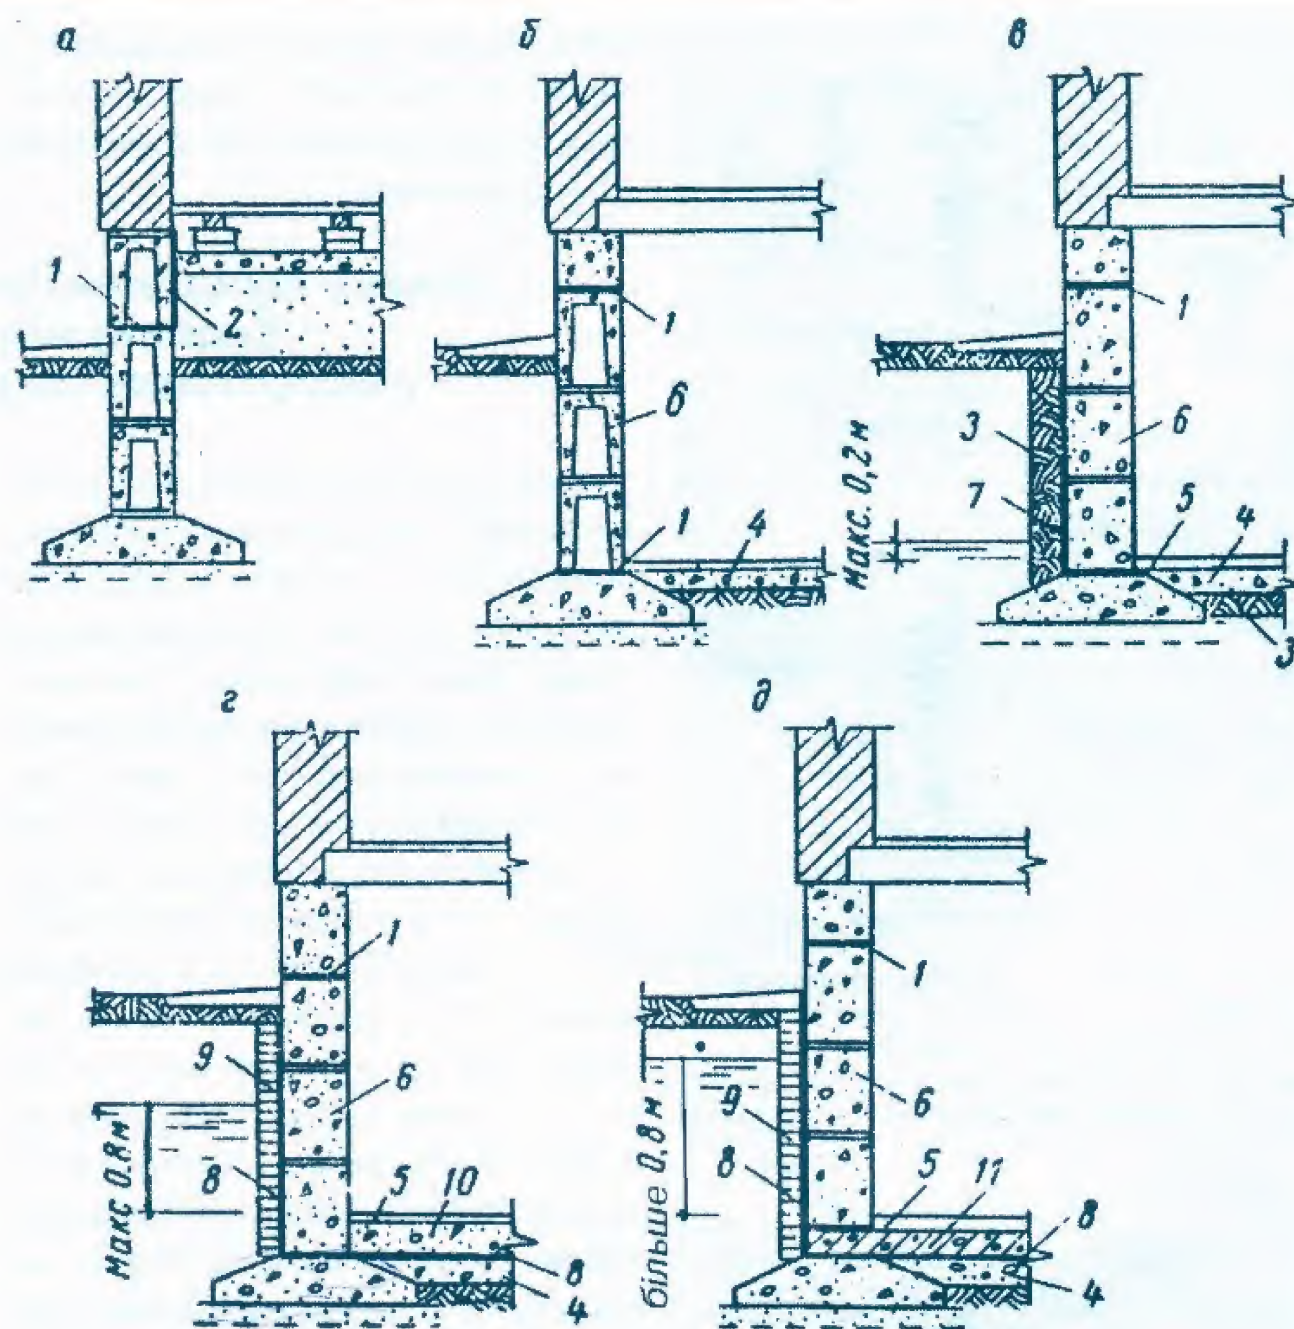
Ізоляція будинку від ґрунтової вологи: а,б – гідроізоляція за відсутності напору підґрунтових вод; в,г,д – те ж, при напорі підґрунтових вод (а – будинок без підвалу; на інших малюнках будинки з підвалом); 1 – горизонтальна гідроізоляція; 2 – вертикальна гідроізоляція; 3 – м'ята масна глина; 4 – бетонний підмурок; 5 – чиста підлога; 6 – стіна підвалу; 7 – обмазка гарячим бітумом; 8 – гідроізоляційний килим; 9 – захисна стінка; 10 – бетон; 11 – залізобетонна плита.
